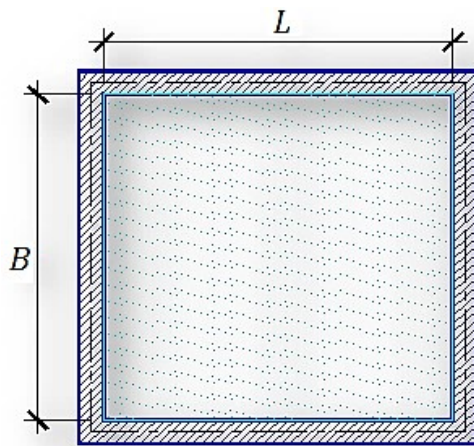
Vista en planta de Reservoirio de 10.00 m3.
